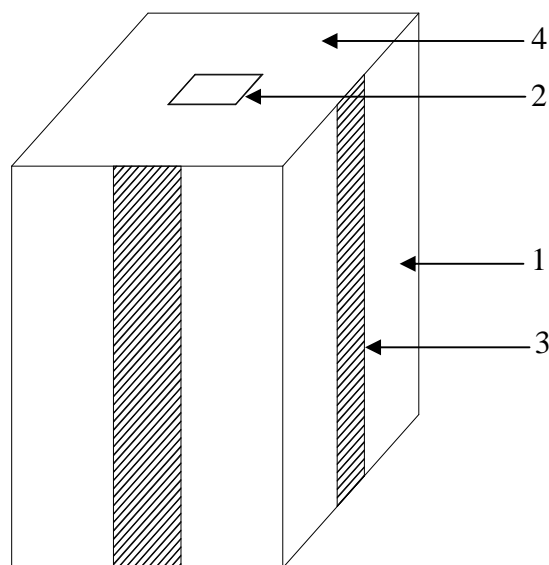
Renforcement d'une structure comportant un noyau en béton armé.
